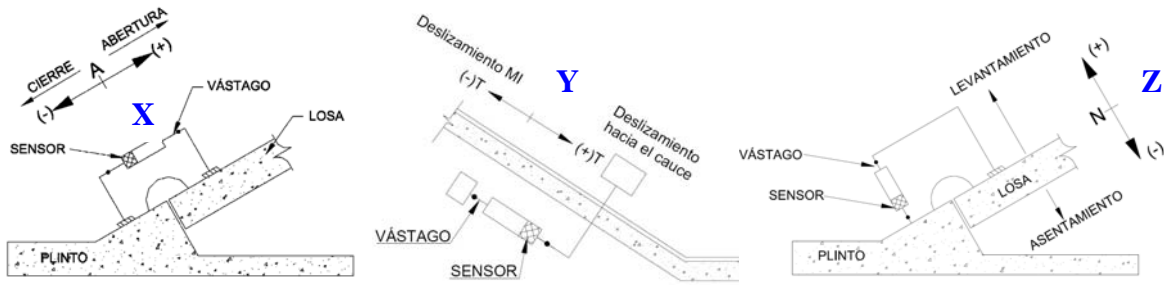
Detalle de los medidores de juntas tridireccionales.
